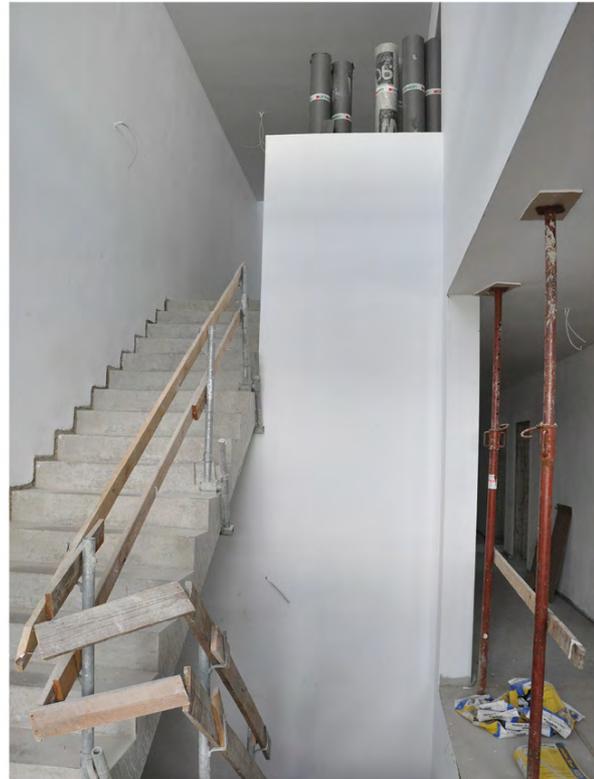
Treppenhaus Erdgeschoss, 15.05.2019
